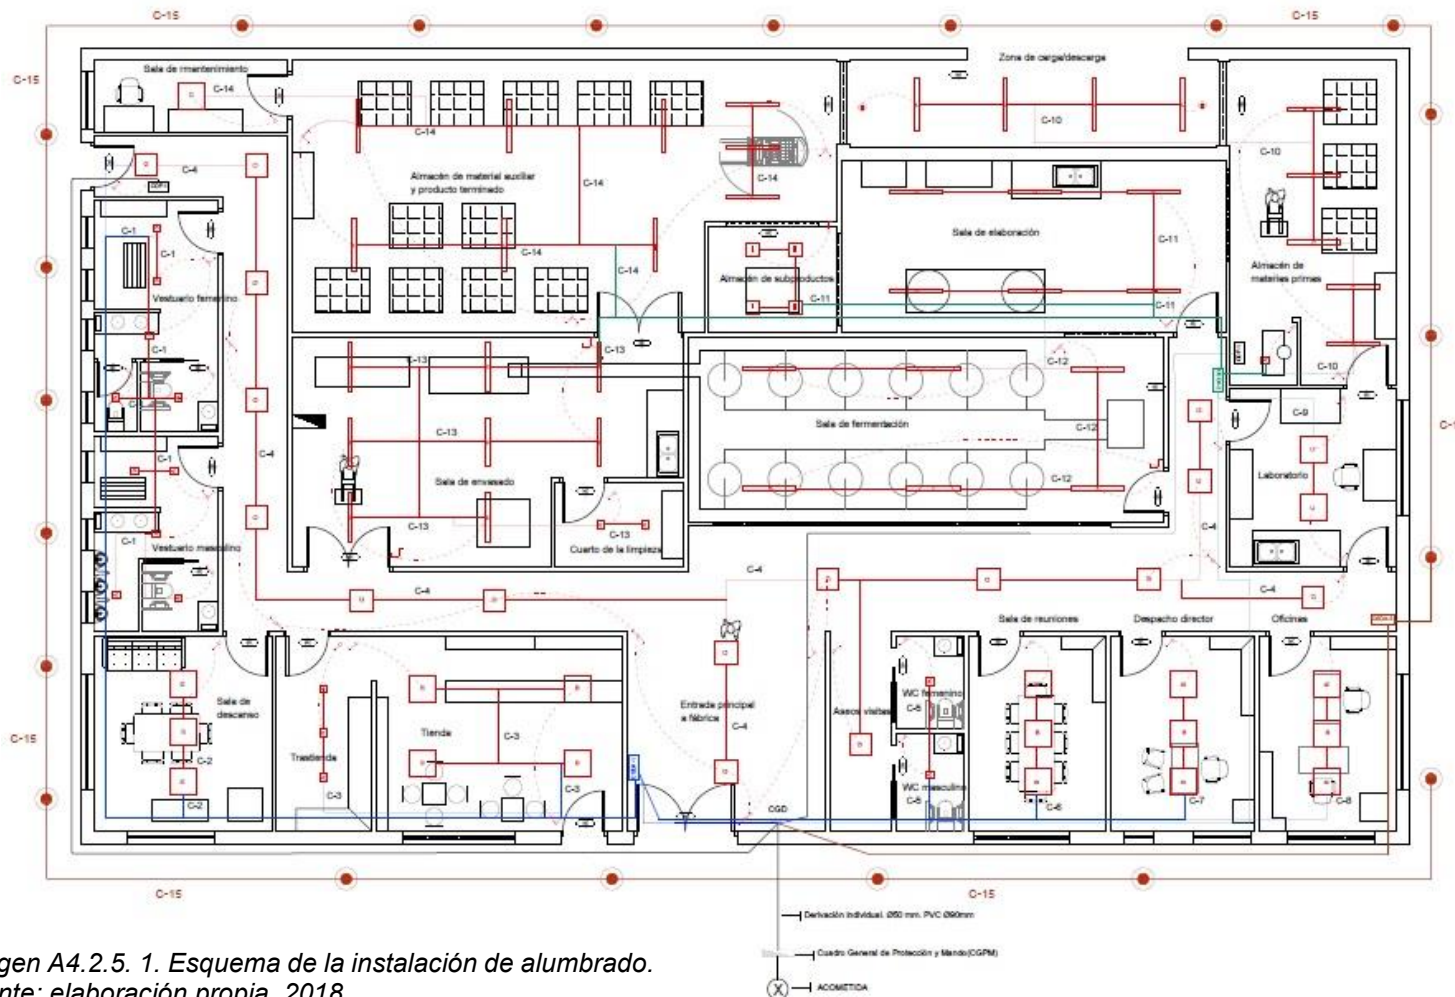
1. Esquema de la instalación de alumbrado.
